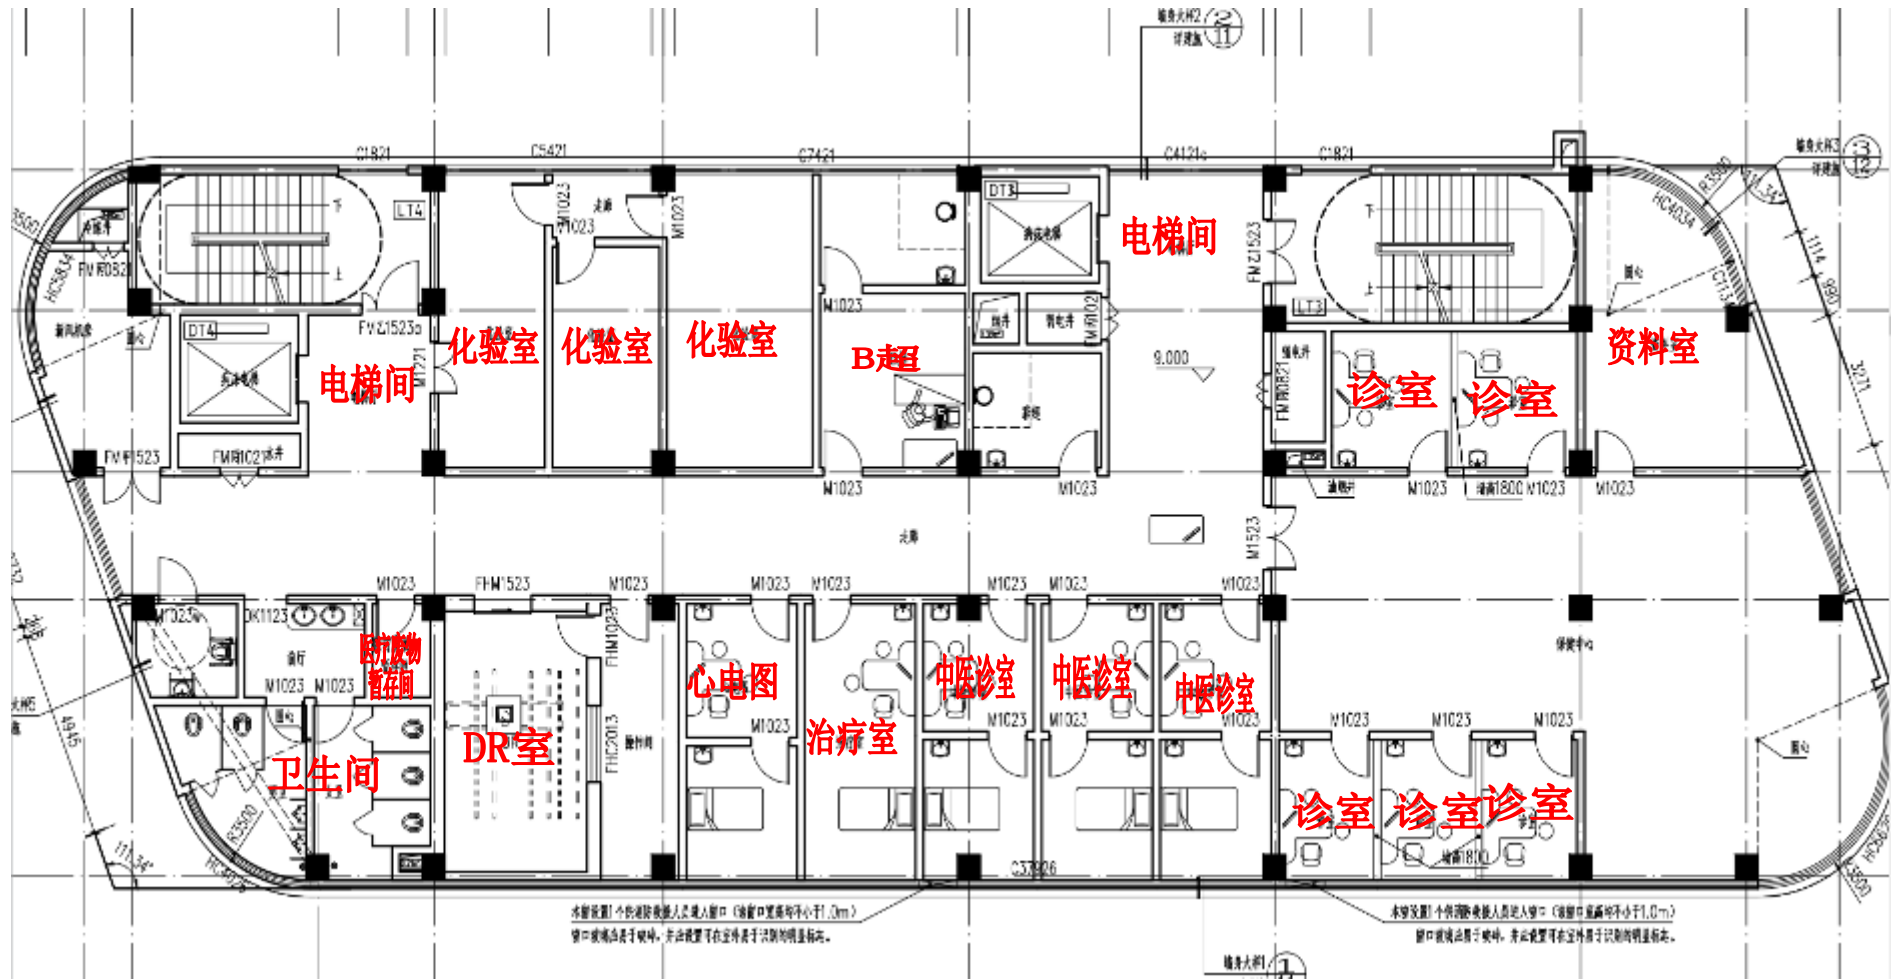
项目第二社区卫生服务中心大楼三层平面图
